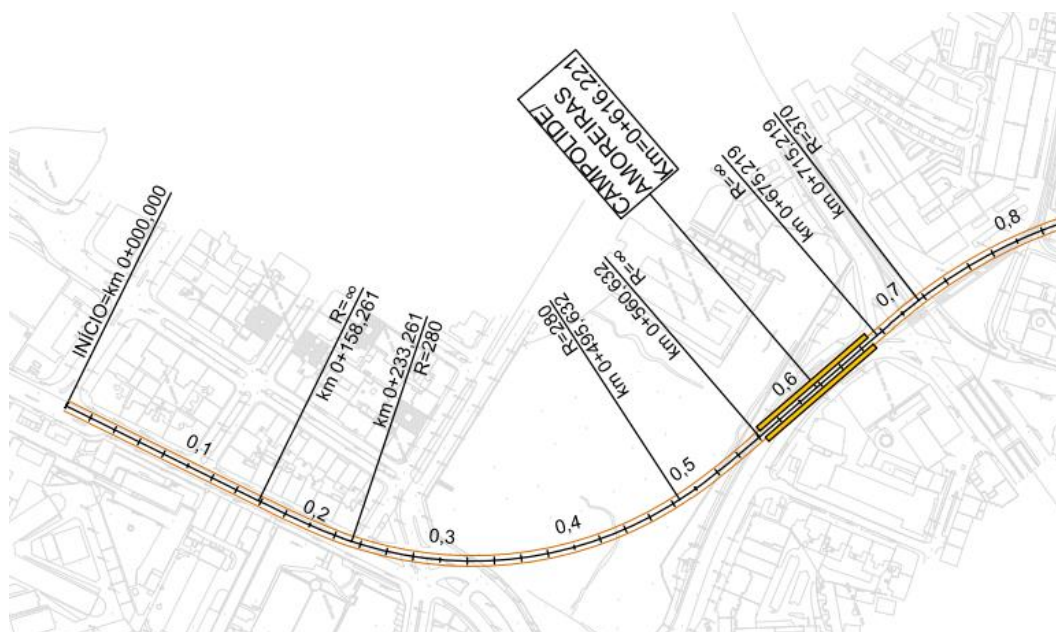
Traçado em planta – 85º Troço: Amoreiras – S. Sebastião
